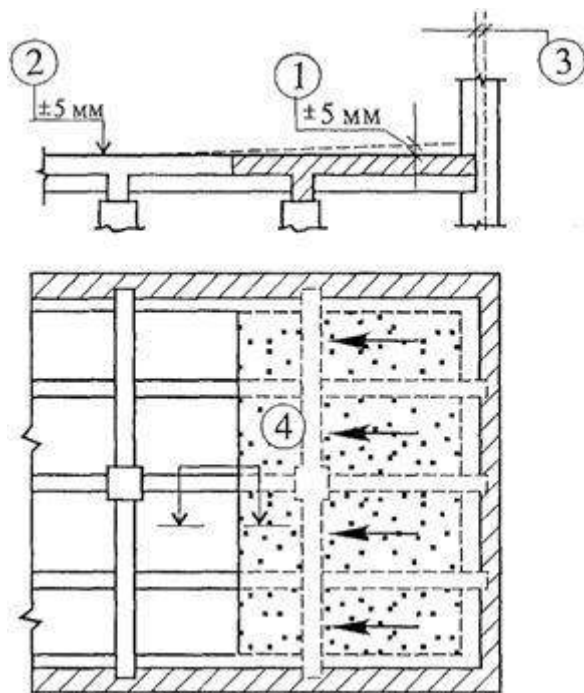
Схема предельные отклонения монолитному перекрытию
